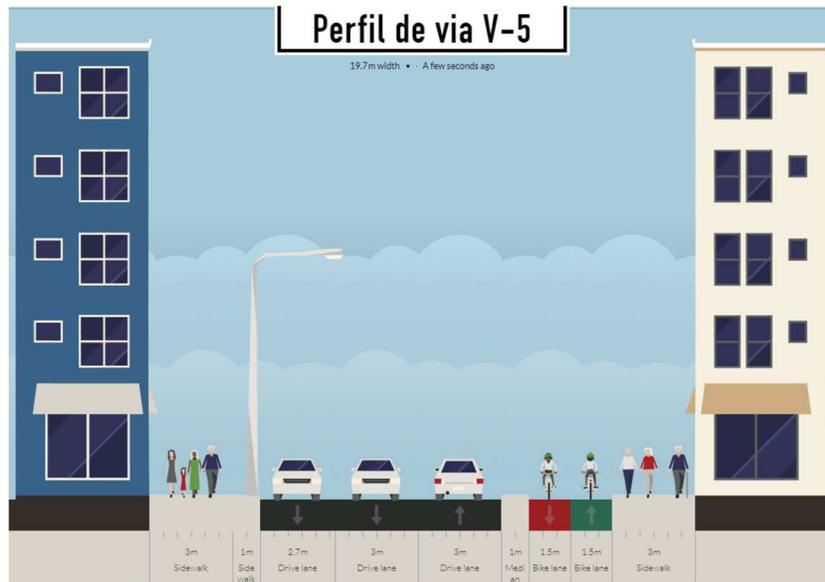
Ejemplo de perfil de vía de ciclorruta (Vía V-5) Entrada al Plan Parcial. Fuente; Elaboración propia.
